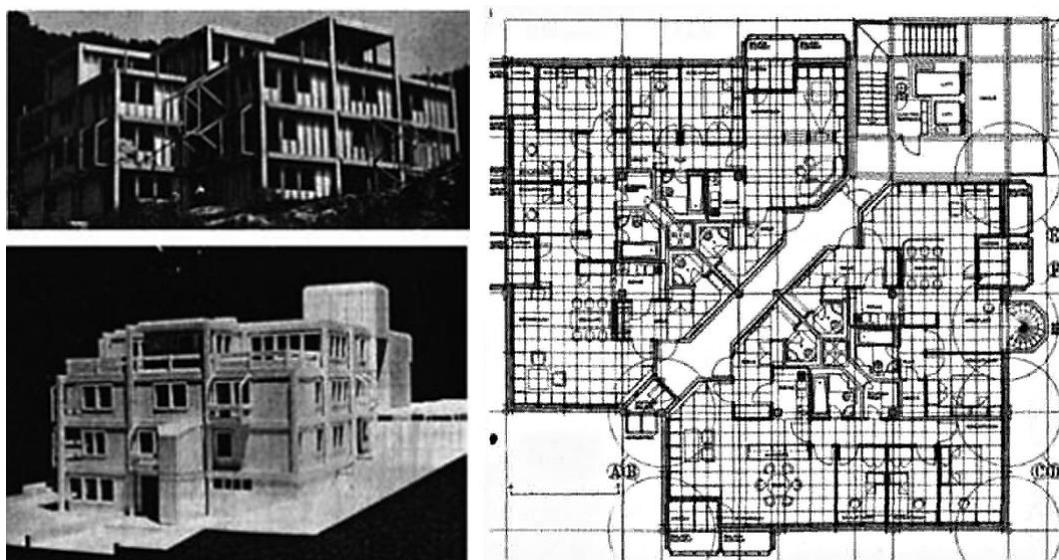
Linz Haselgraben (1976), maquete e planta baixa.
